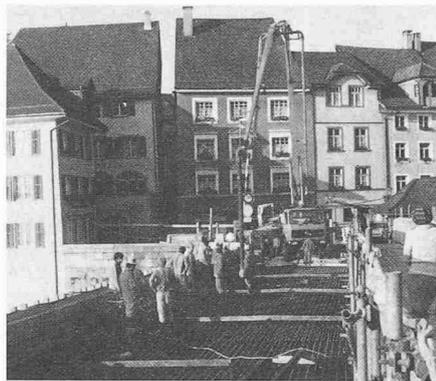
Armierung und Betonieren der Stahlbetonplatte
